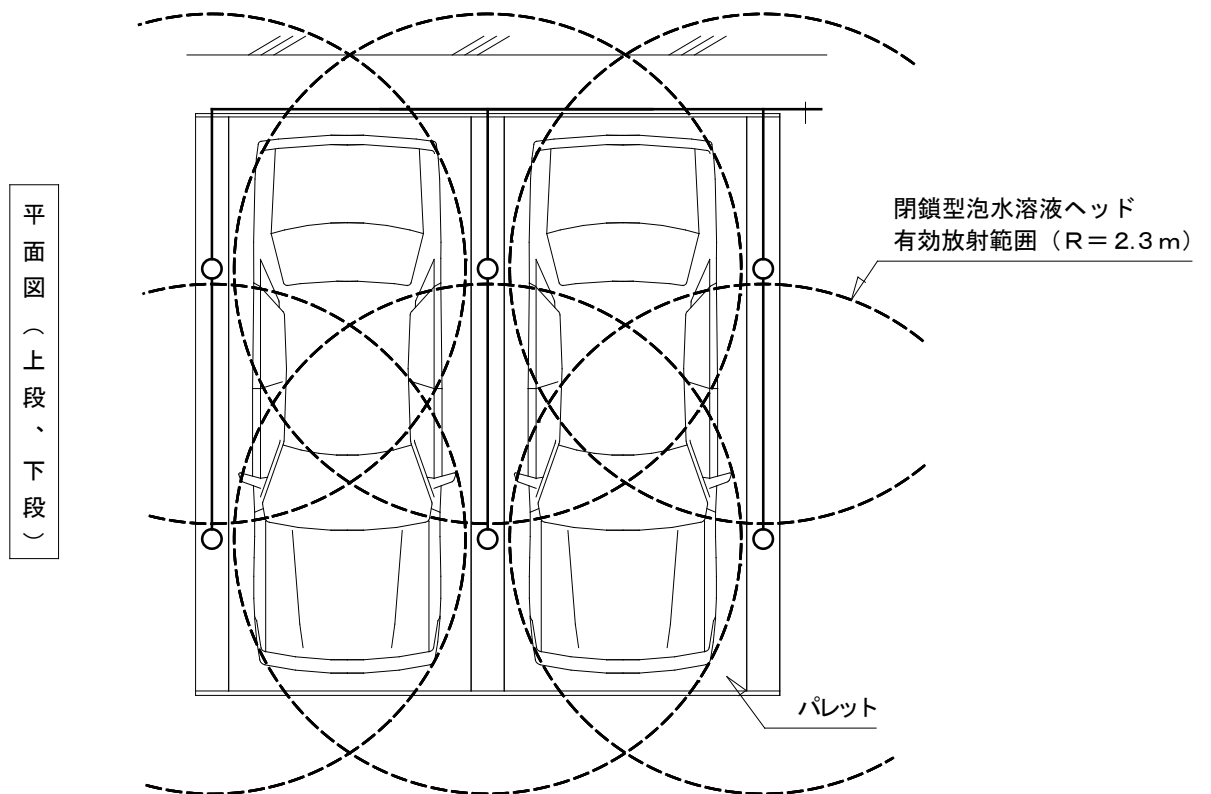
機械式駐車場設置例 (その 1)、平面図 (上段、下段)
